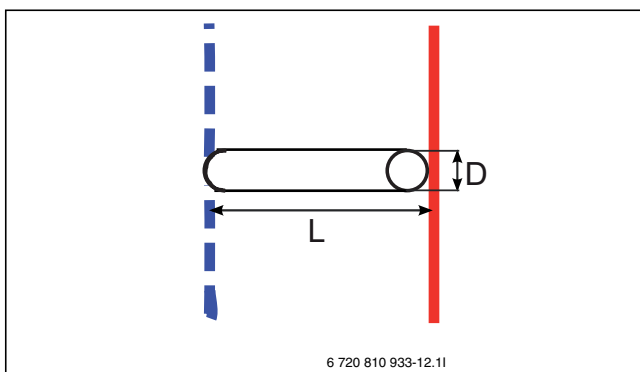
Bypass Detailansicht (→ [1] Abb. 2 und 3)
